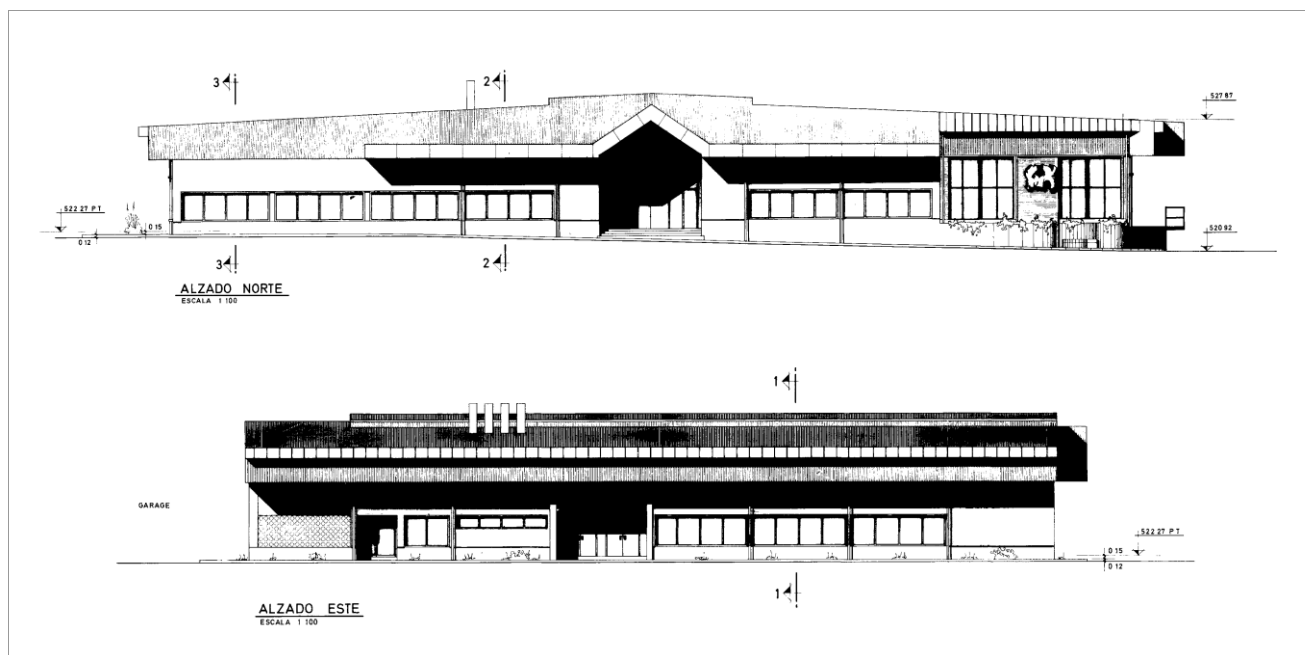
Vista de las fachadas norte y este del edificio de comedor según planos originales
